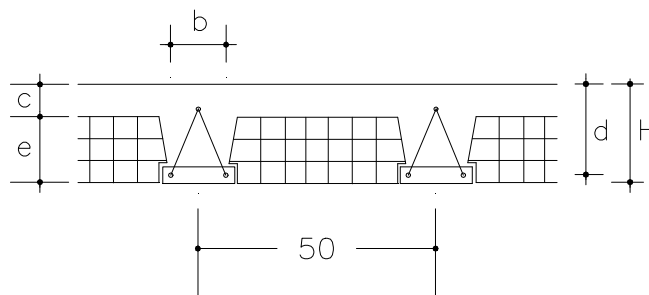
Seção Transversal das Lajes com Vigotas Treliçadas
